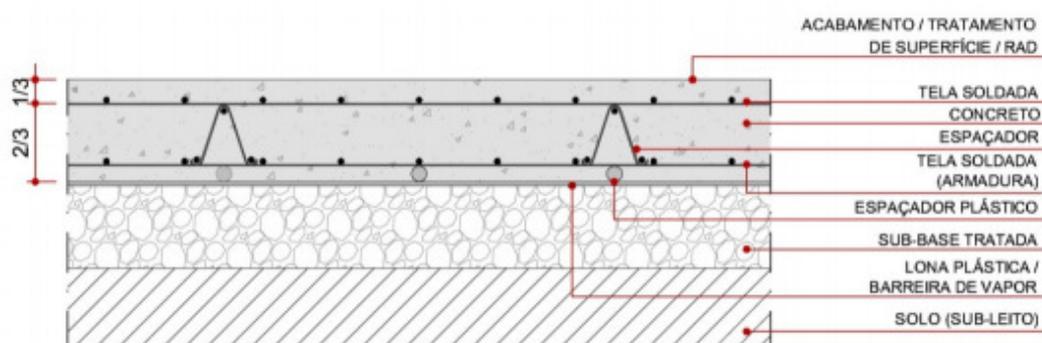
Pavimento de concreto com armadura distribuída continuamente
